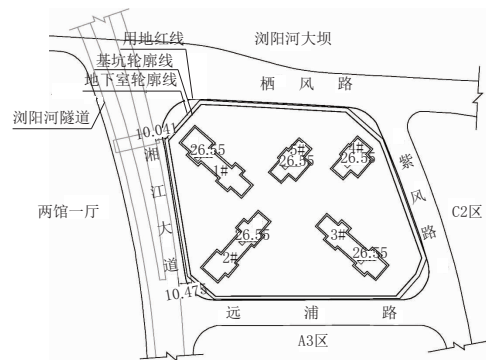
建筑平面与既有隧道平面位置关系图(单位:m)
